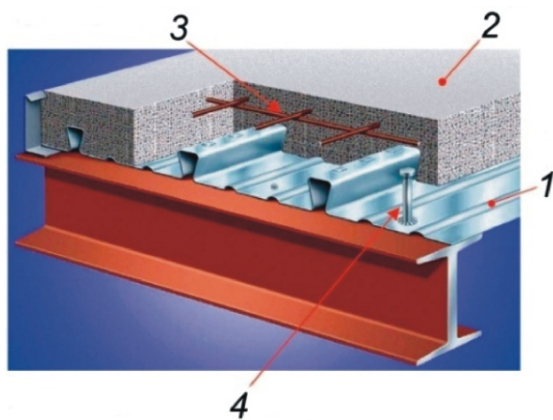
Залізобетонна плита перекриття із зовнішнім листовим армуванням:
